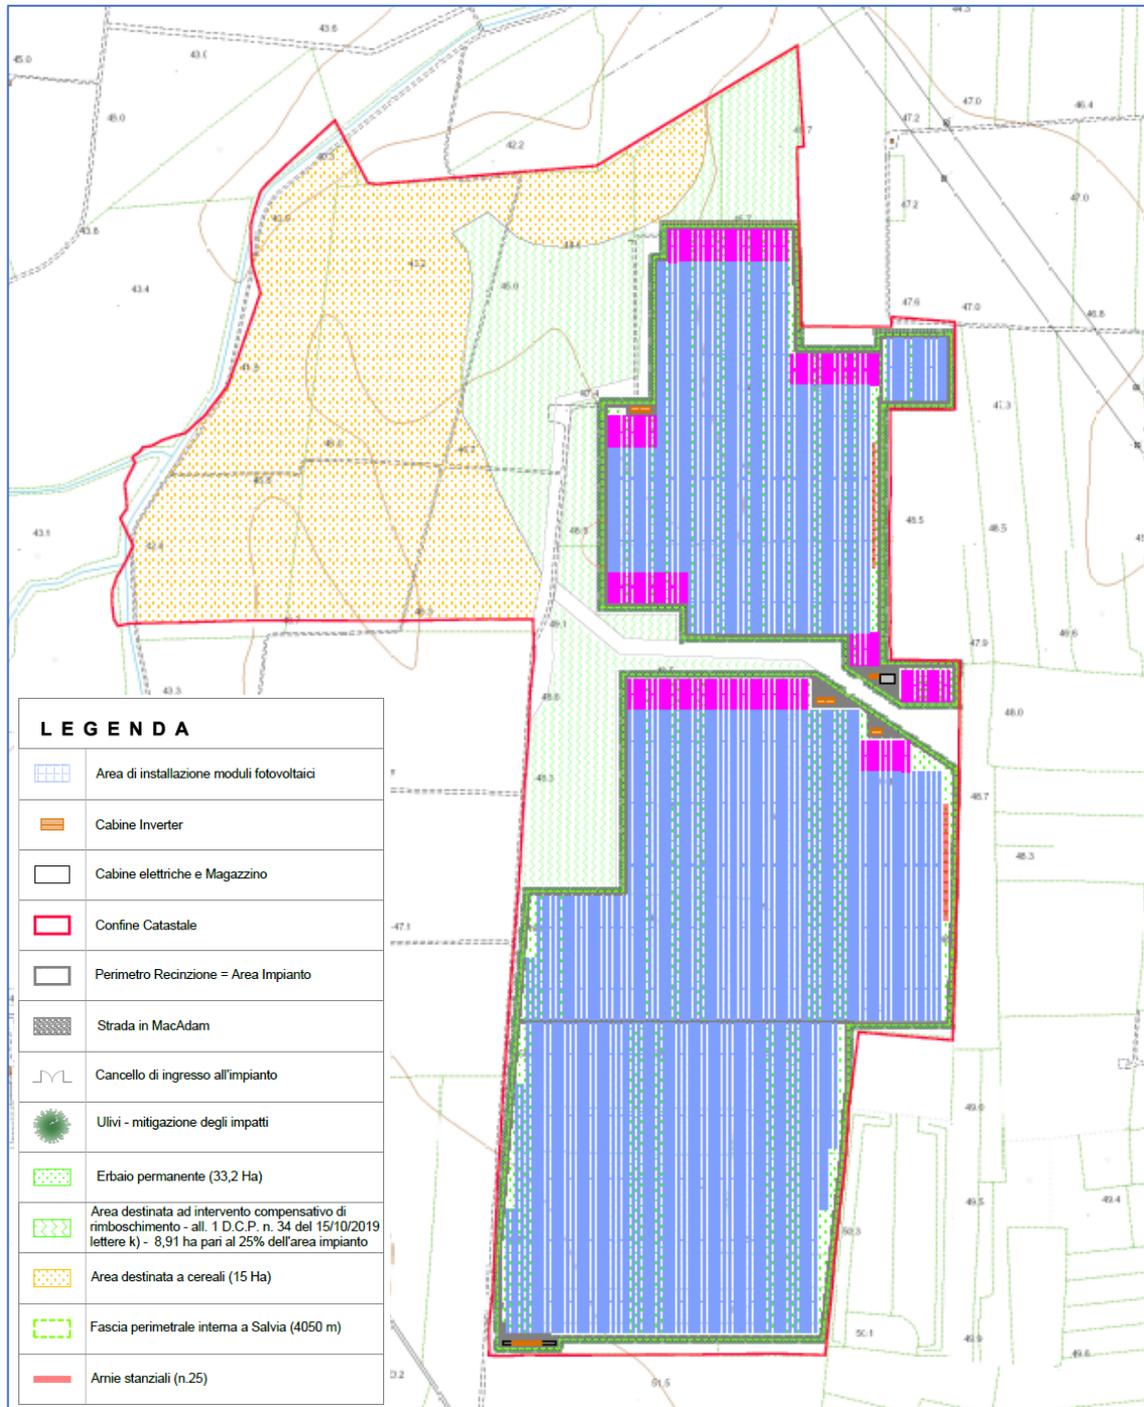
Stralcio elaborato 018_MRR-CIV-TAV-018a_03 - Layout impianto inerbimento e mitigazione
